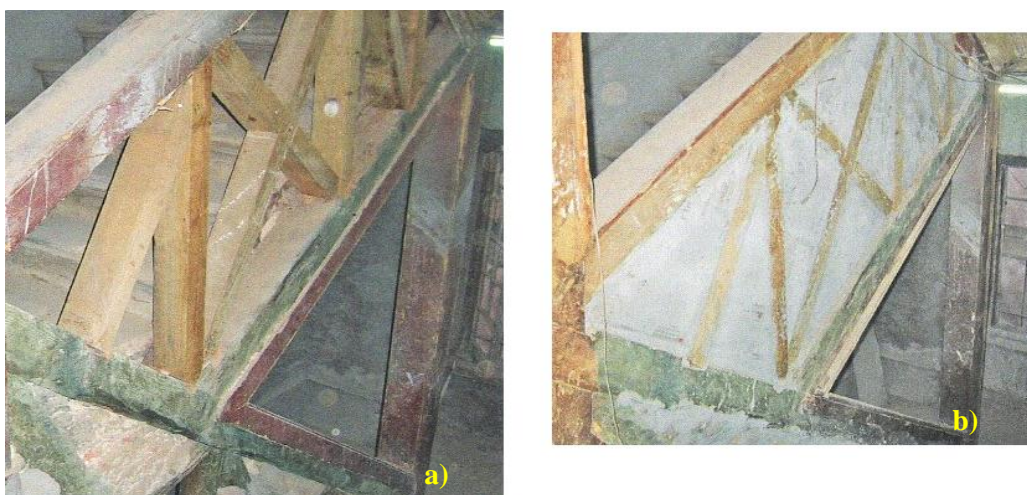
Pormenor construtivo das escadas pombalinas (adaptado de Pinho, 2008).
